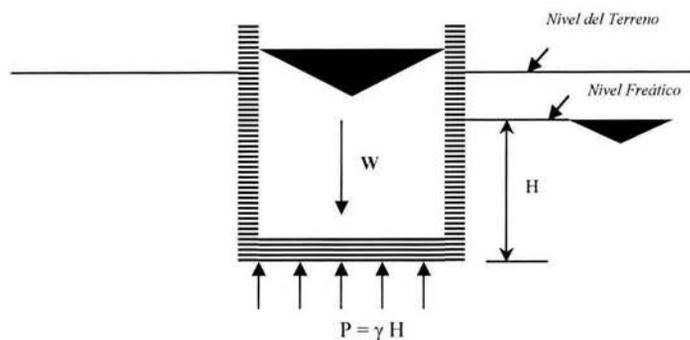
Efecto de la subpresión en una estructura enterrada bajo el nivel freático
